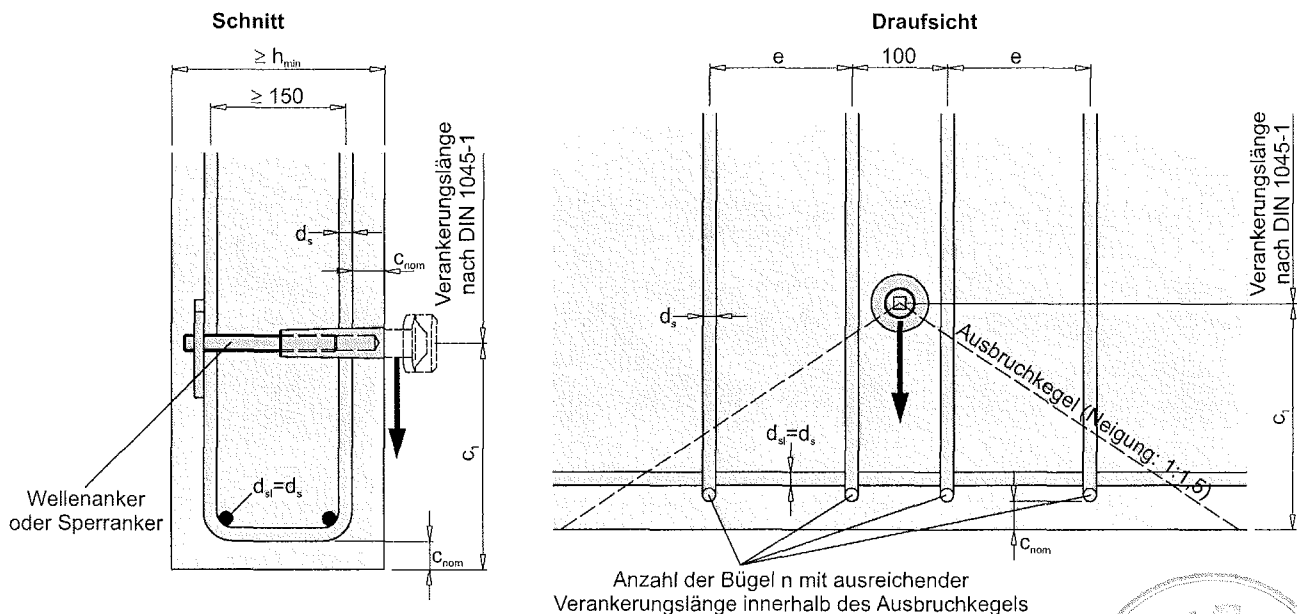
Einbausituation in Wänden - Querbeanspruchung mit Rückhängebewehrung - Bewehrungslage
